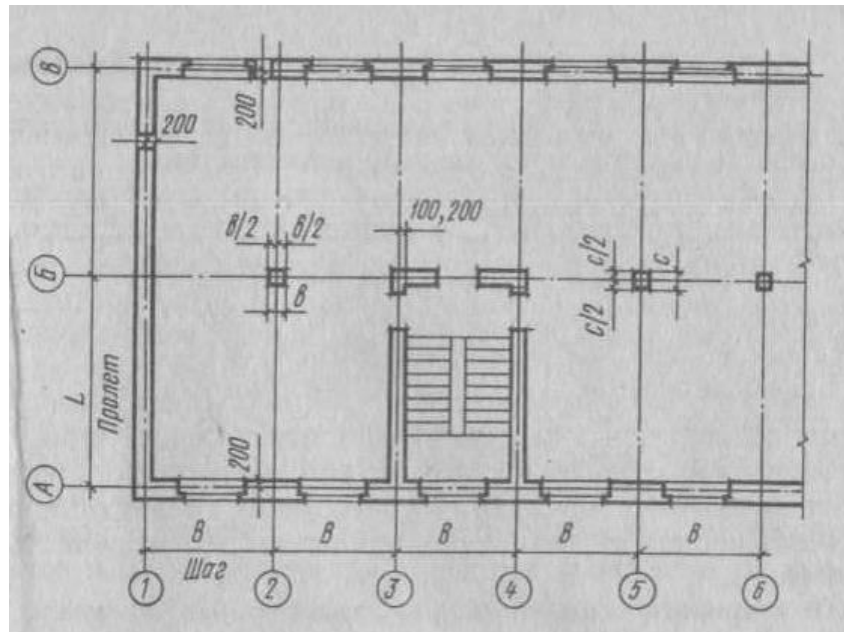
Конструктивна схема будівлі з неповним каркасом (план)
